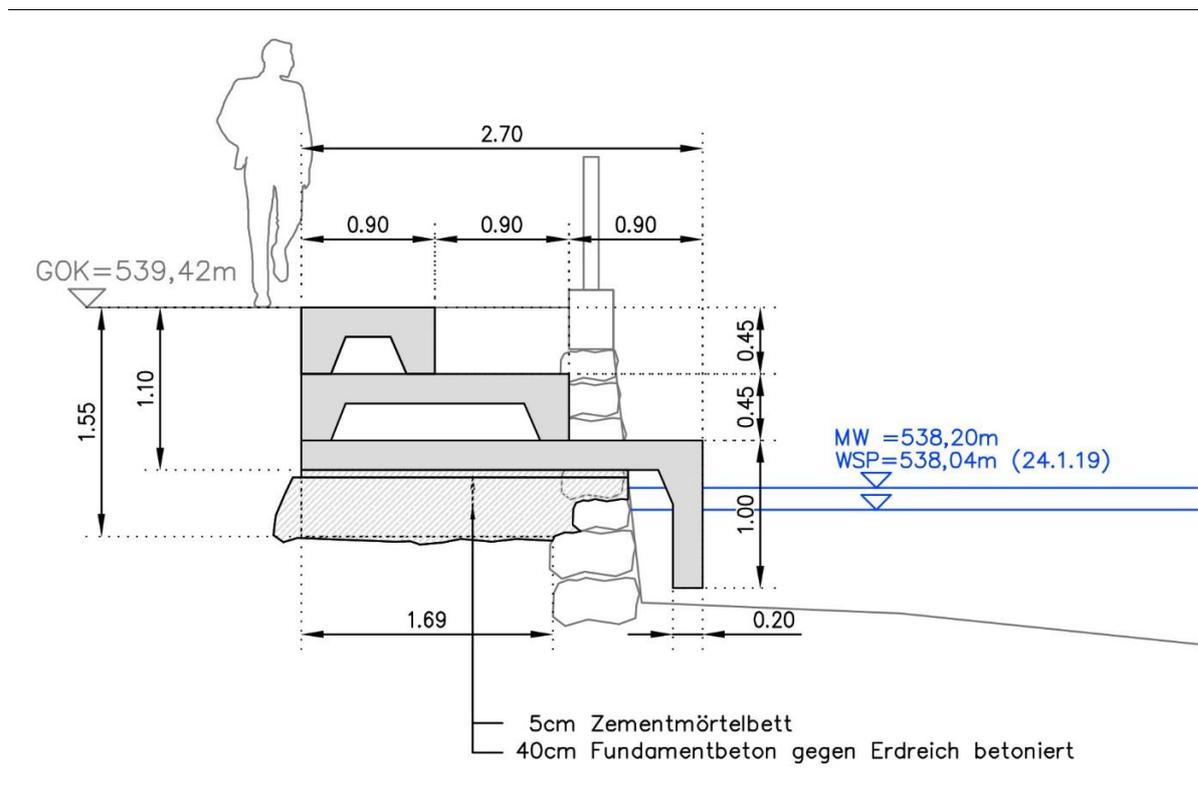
Regelquerschnitt M 1:50 der abgetreppten Ufermauer mit Fundamentbeton und zu ertüchtigender Bestandsmauer. Quelle: A. Greinmeister, Werner Consult ZT GmbH
